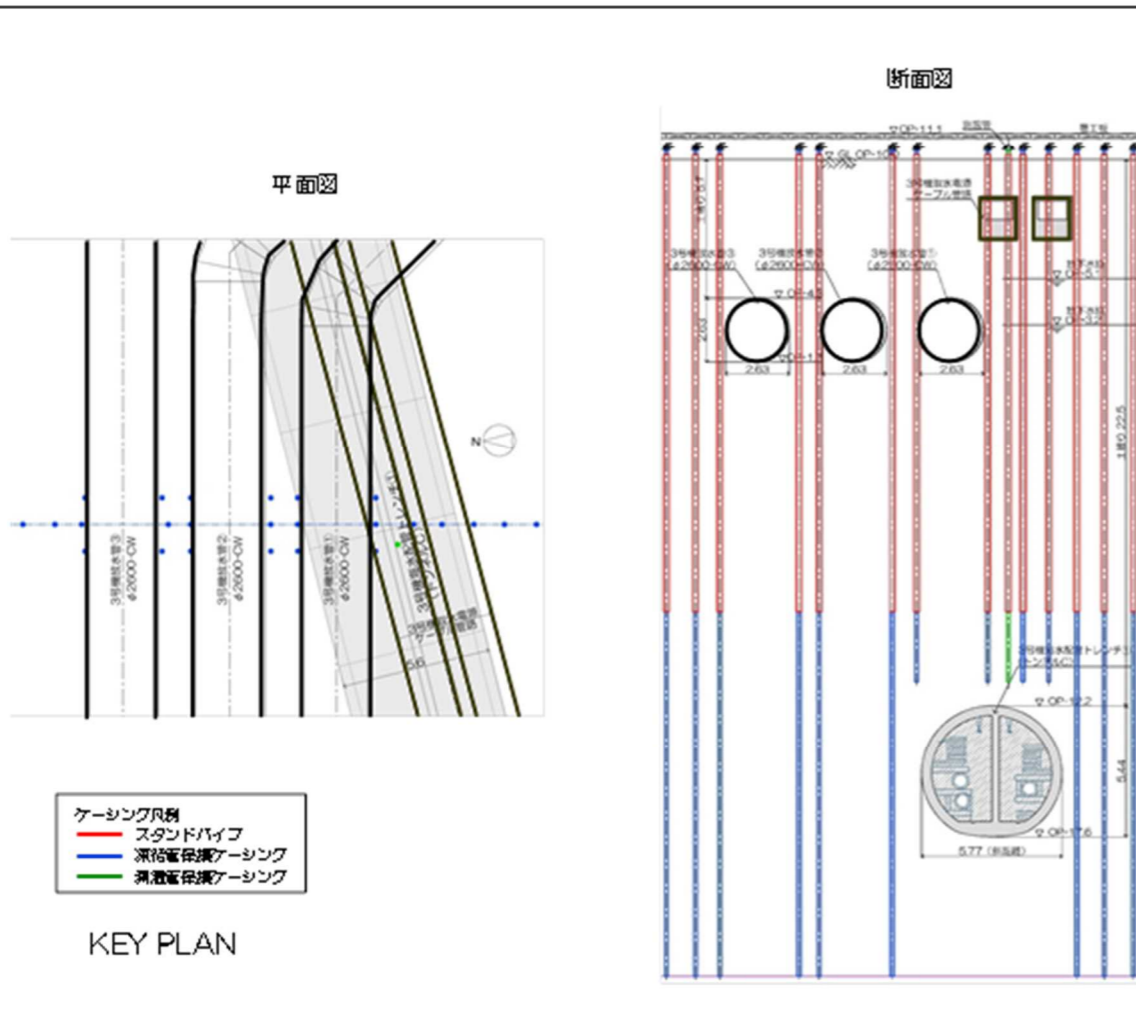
【11-9】3号機放水管①②③ 施工方法 (複列施工)
